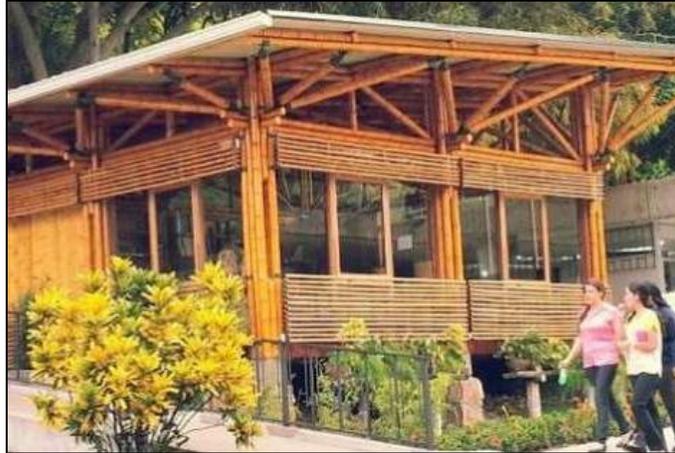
Imagen referencial de una edificación con estructura de caña guadua
